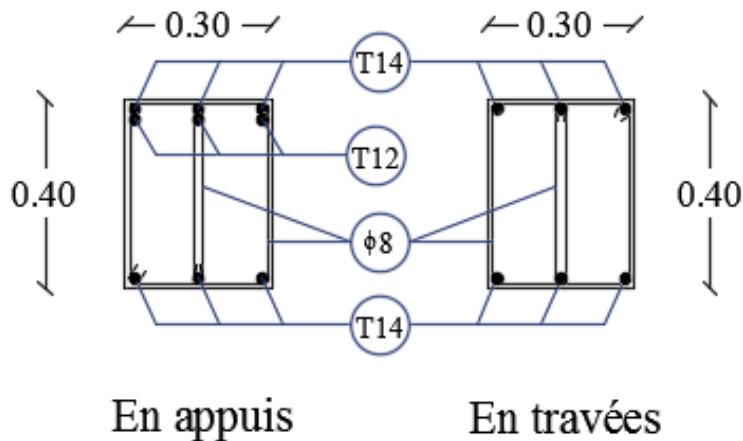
Ferrailage des poutres secondaires (bloc A1 & A2)
